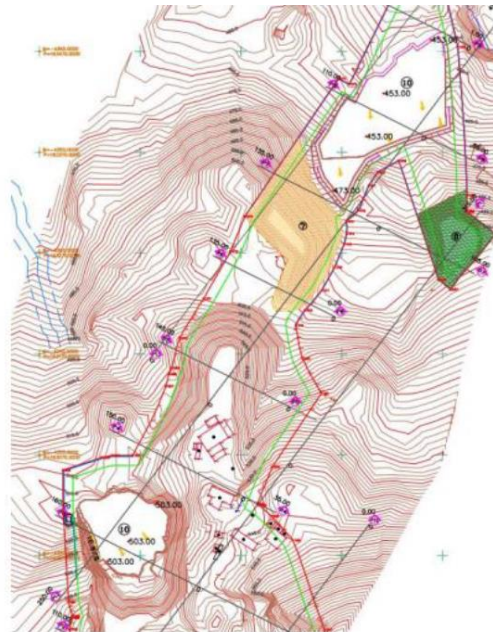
Extrato da planta da exploração ao fim de 3 anos. (Fonte: Plano de Lavra)
